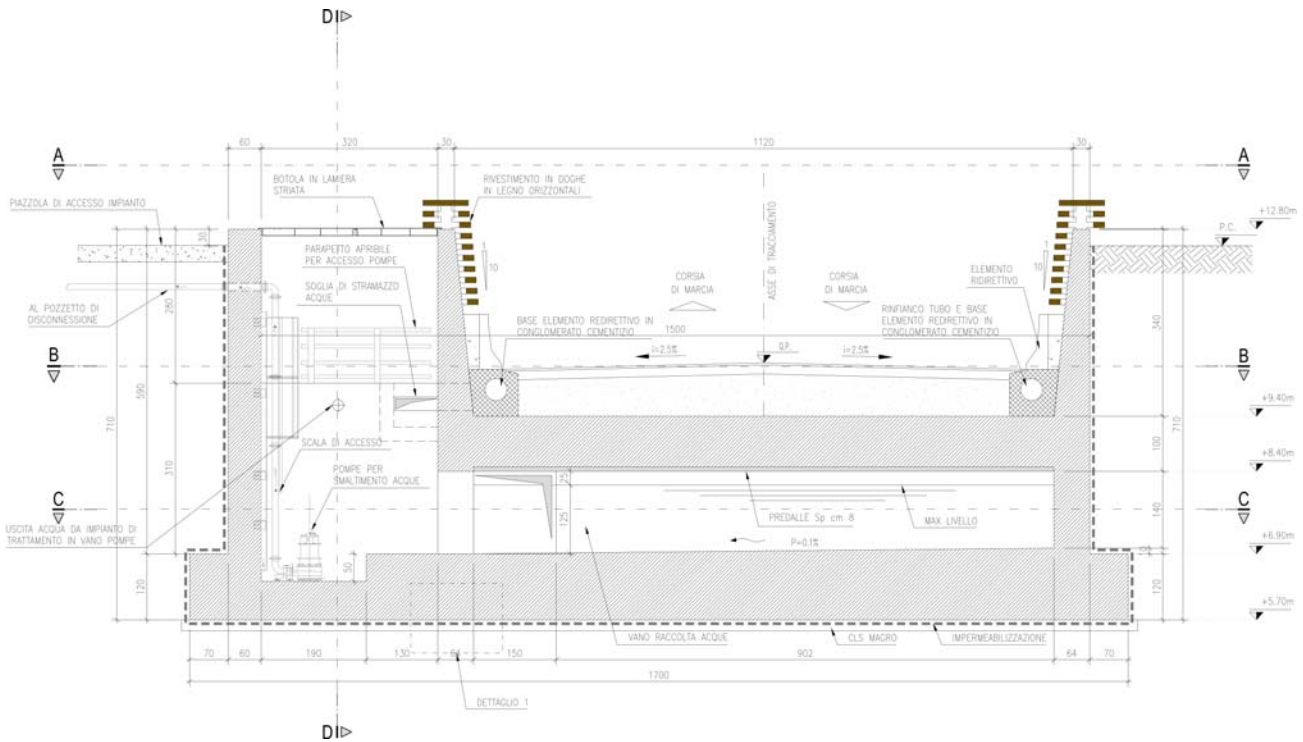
SEZIONE TRASVERSALE F-F.
